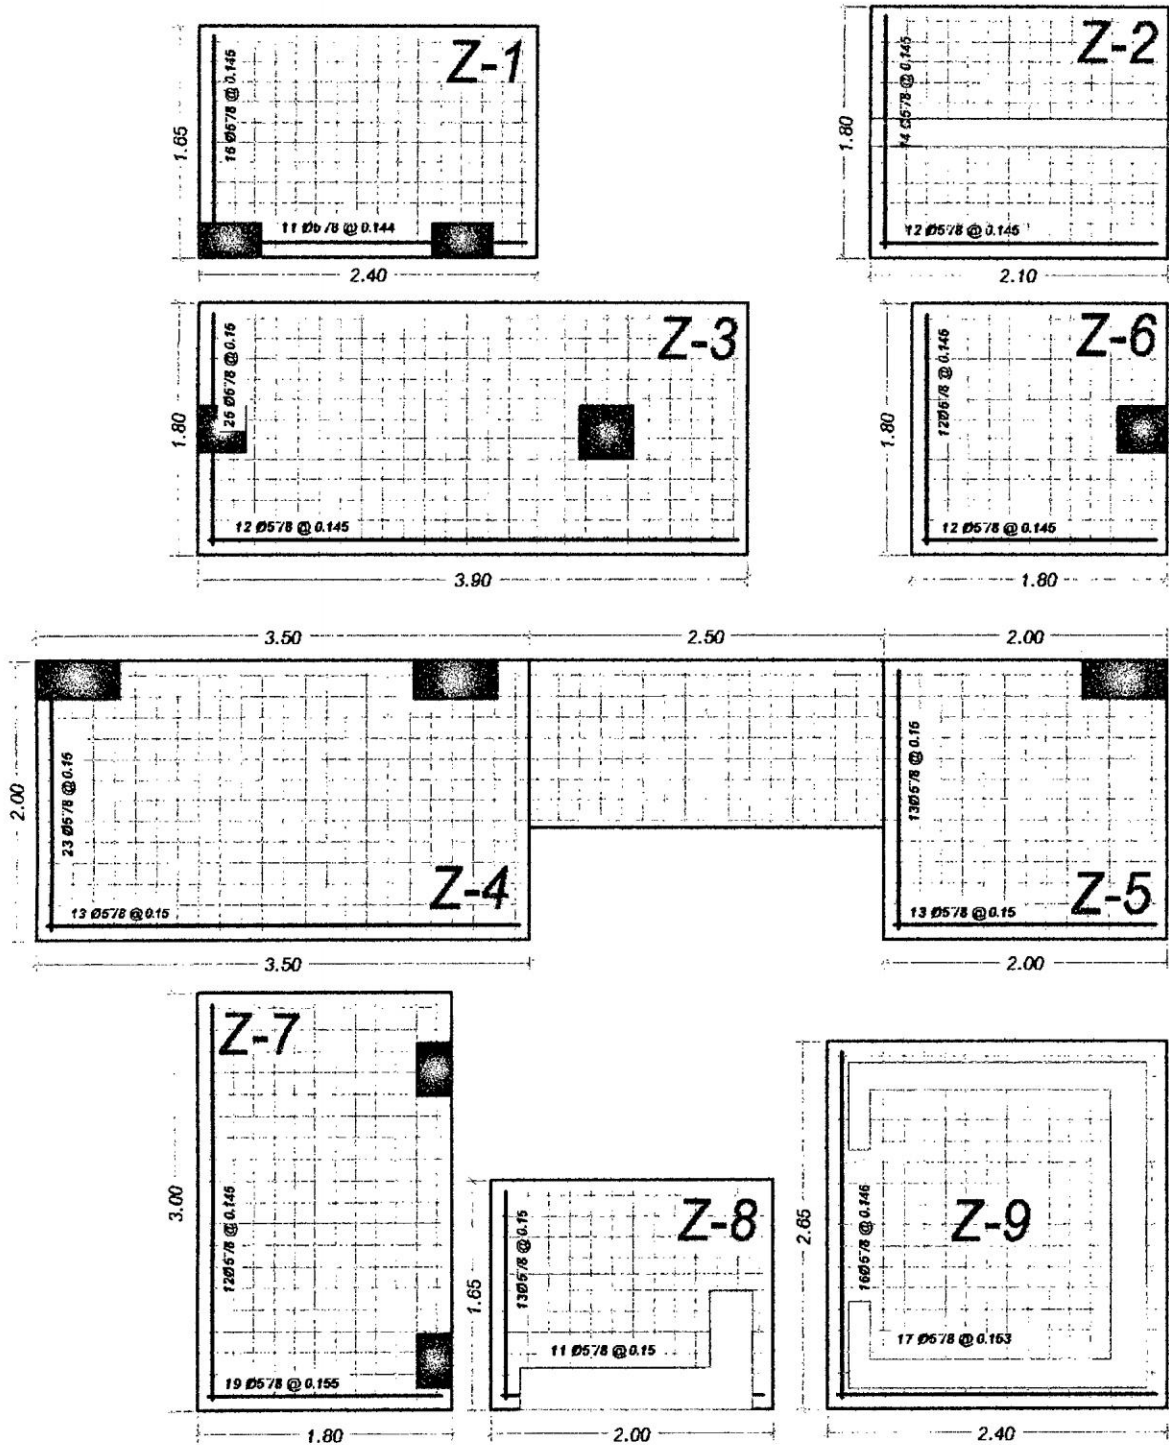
Armado de las Zapatas de los muros de concreto armado
